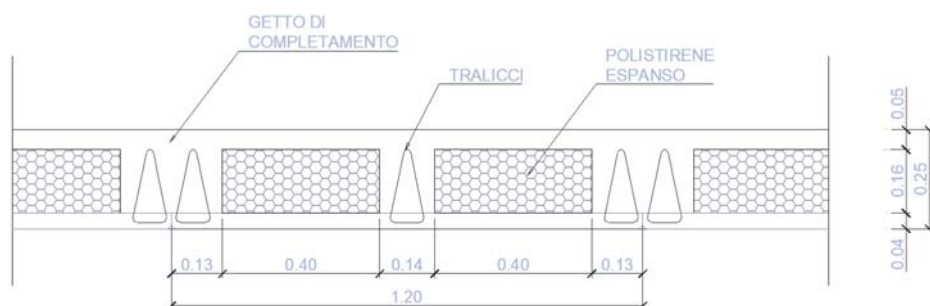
SEZIONE TIPO SOLAIO
